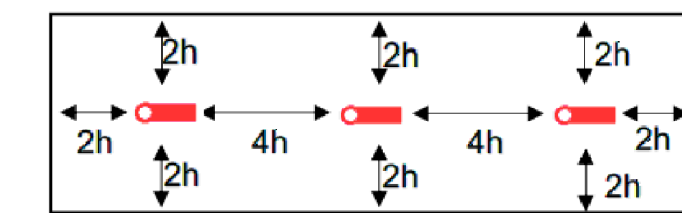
Exemplo de indicação em planta baixa de instalações de pontos de luz para iluminação de emergência, sendo h = altura da instalação.
